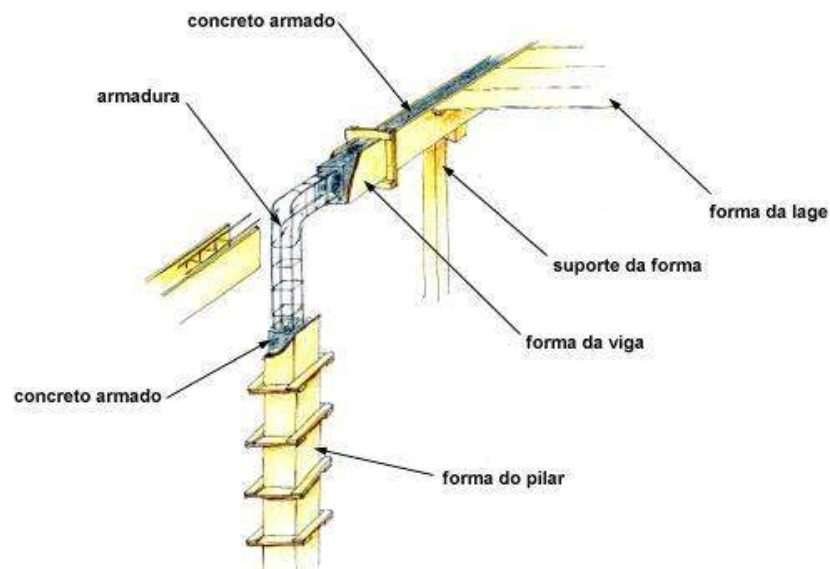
elementos básicos da estrutura de concreto armado convencional (BIANCO, 2010)
